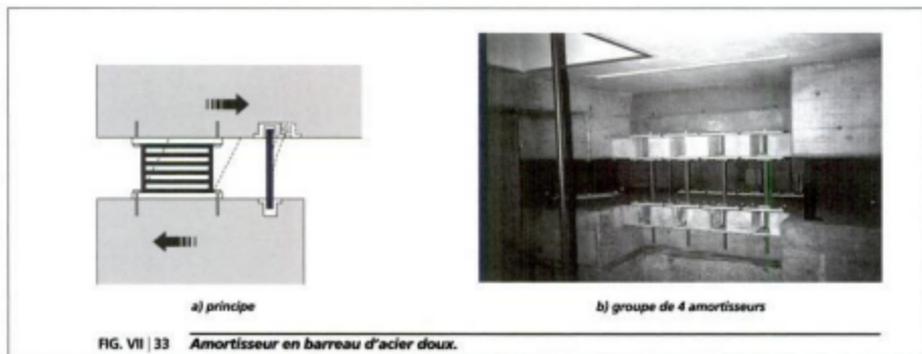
Amortisseur en barreau d'acier doux.
